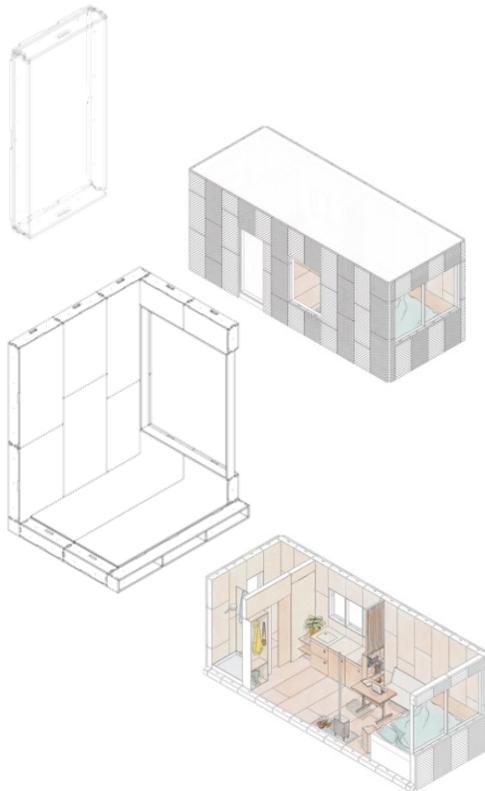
Collage de sistema U-build. Fuente: adaptado de (U-build, 2021).
